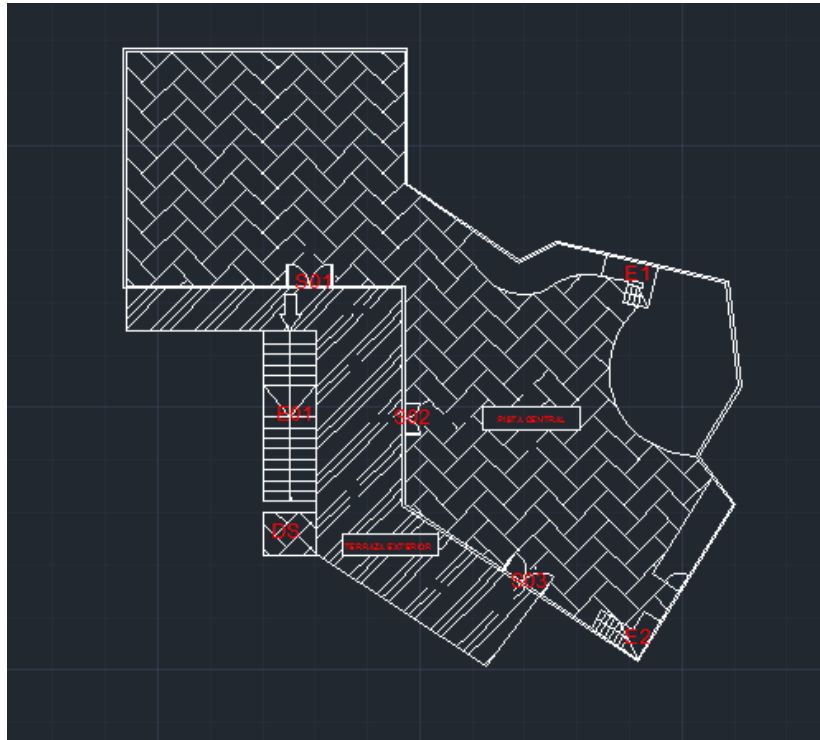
“Plano de la planta del primer piso de la discoteca 1 en formato DXF.”
